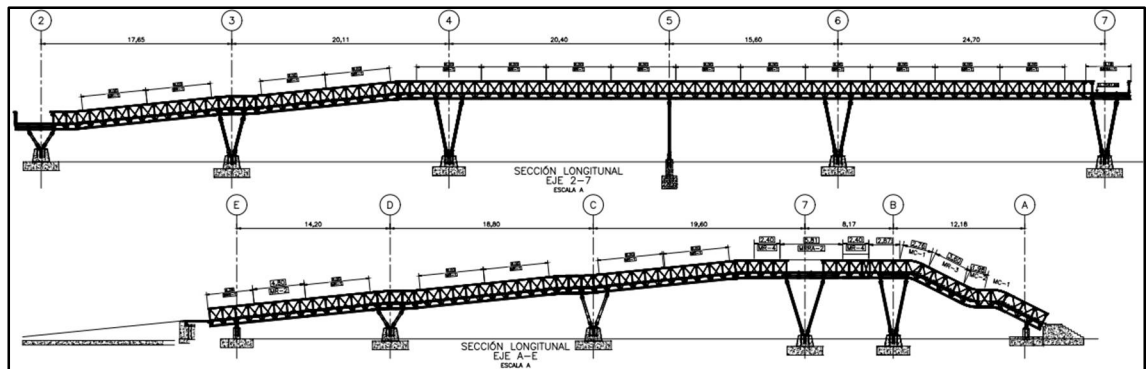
Planta y perfil longitudinal de la pasarela metálica sobre la Av. Boyacá
